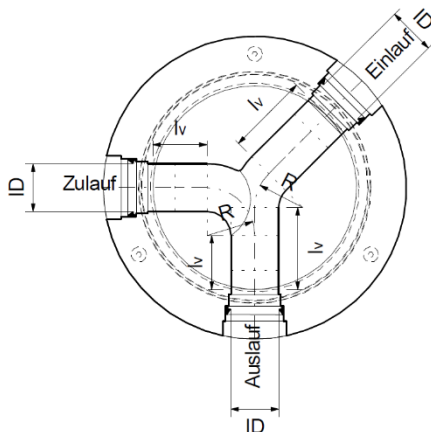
CENTUB® Massschachtunterteil Einlauf und Zulauf Typ 1
